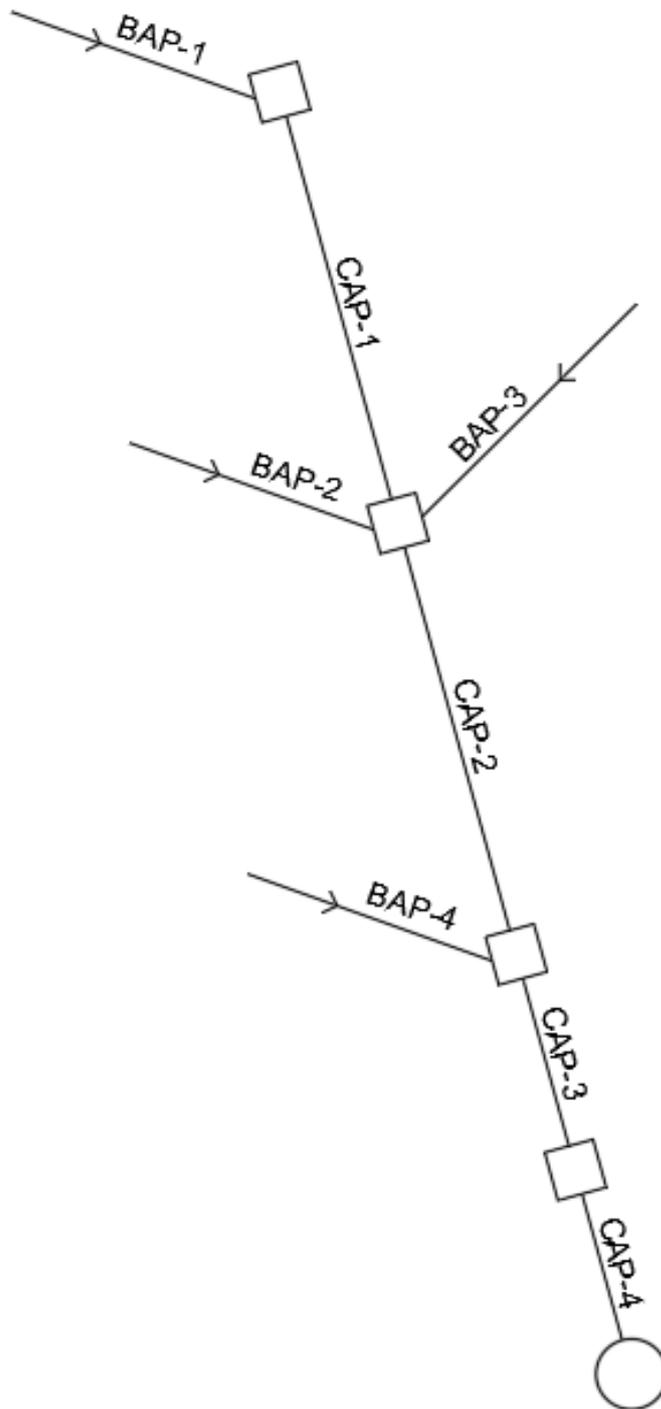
Esquema de colectores de aguas pluviales visto en planta
